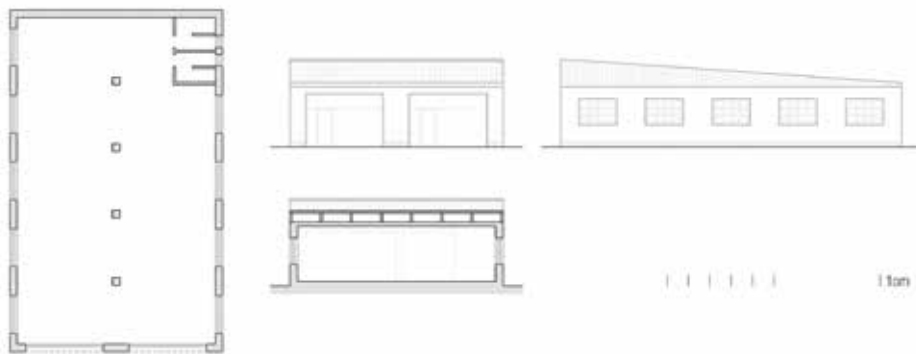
Planimetrías da nave industrial no lugar das Angustias: planta, alzado principal, alzado lateral e sección transversal (reinterpretación da autora).
